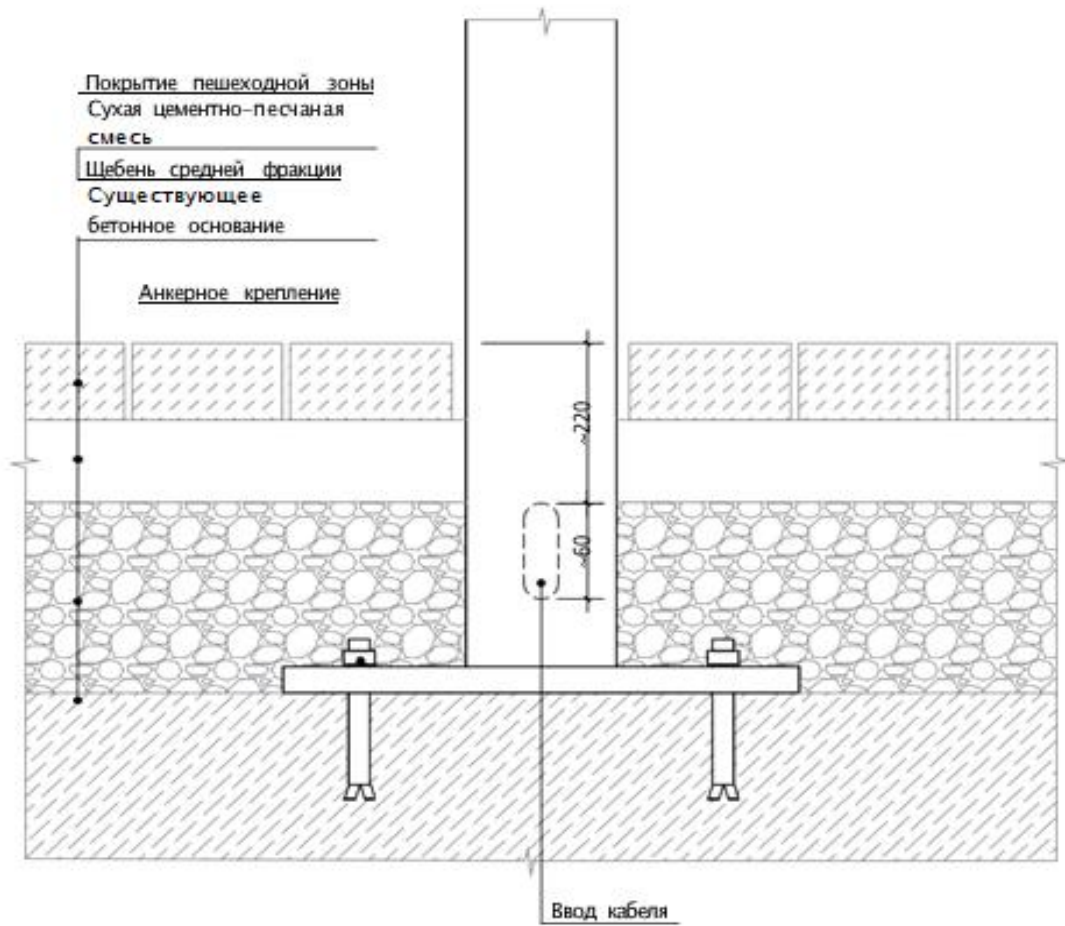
Схема установки опоры на существующий фундамент основания
